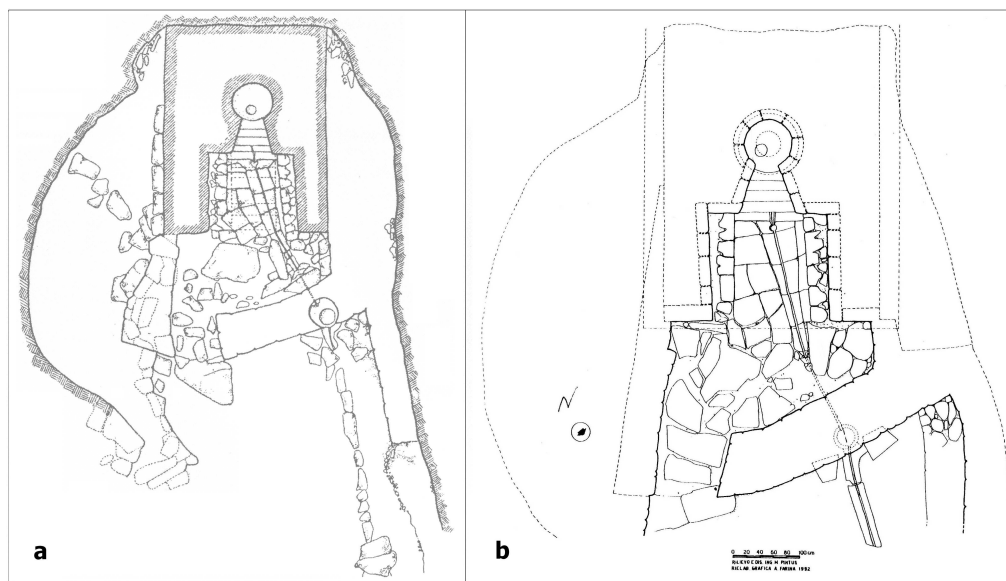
Su Tempiesu: Planimetrie. a - da A.M. Fadda; b – da coop. L.A.R.Co.
